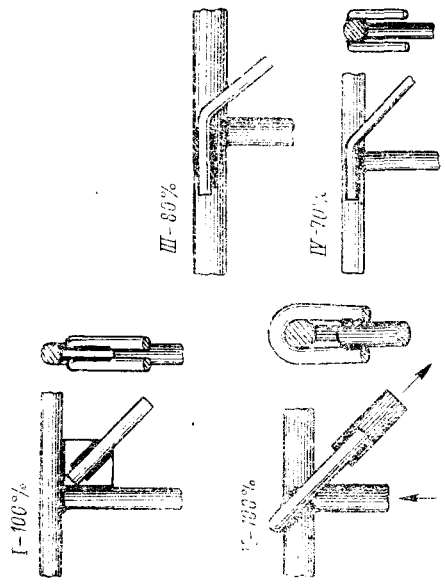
Узлы стержней арматуры гладкого профиля. Относительная прочность сварных соединений с дополнительными конструктивными элементами
